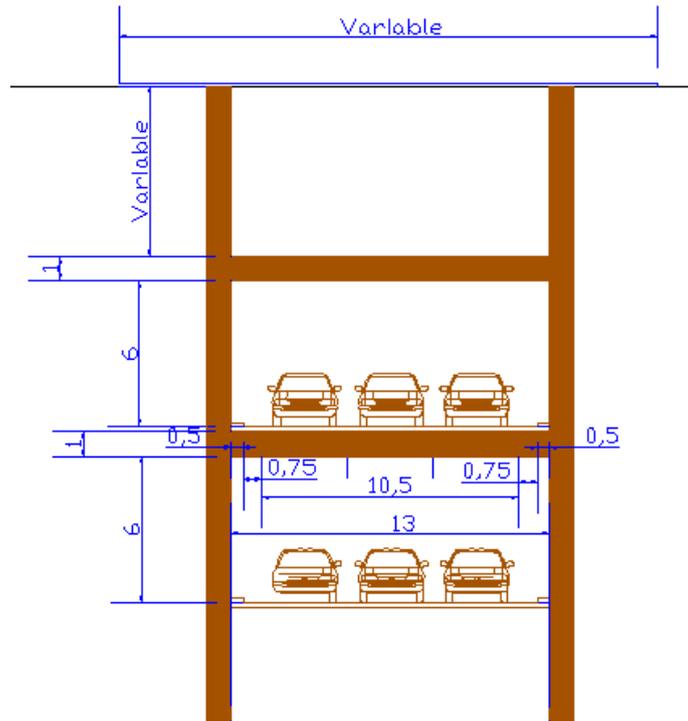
Estructura para Trinchera Cubierta en dos niveles
